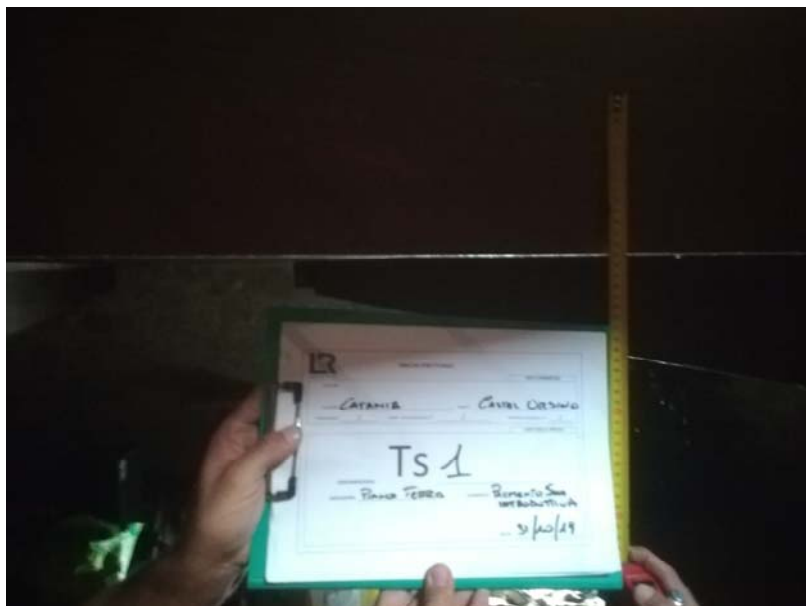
Traccia edile Pavimento 1° Livello ingresso - quota 0.00 m
